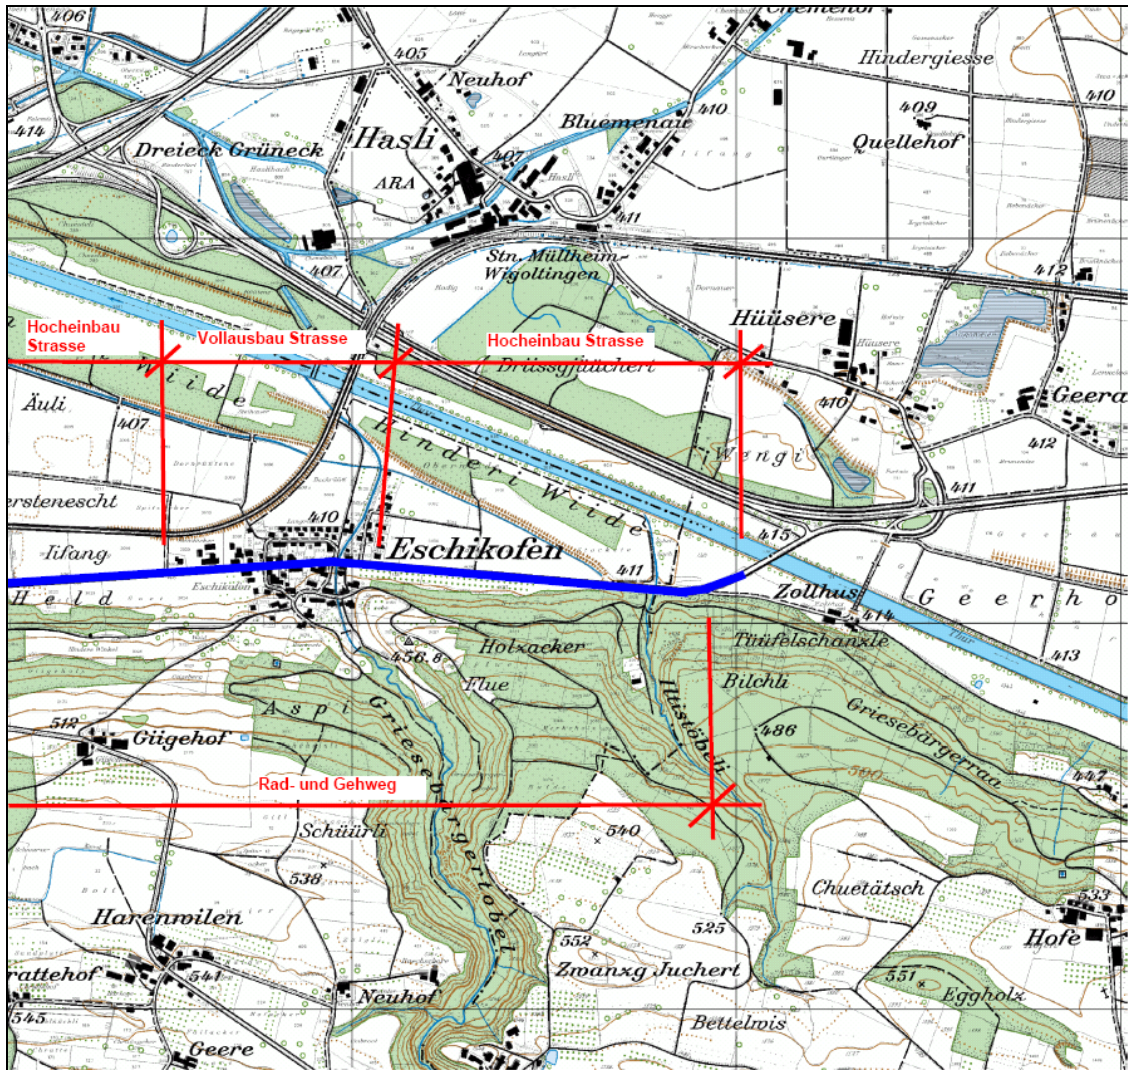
Hüttlingen, Sanierung Betonstrasse Hüttlingen-Eschikofen, Situation 2
